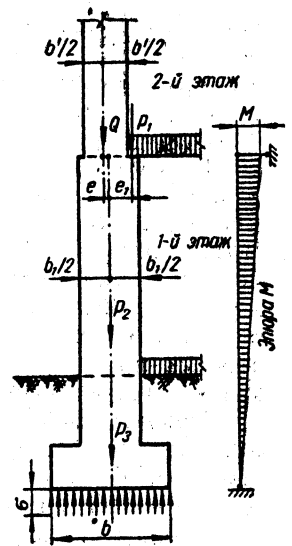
Расчетная схема фундамента здания без подвала с жесткой конструктивной схемой.
